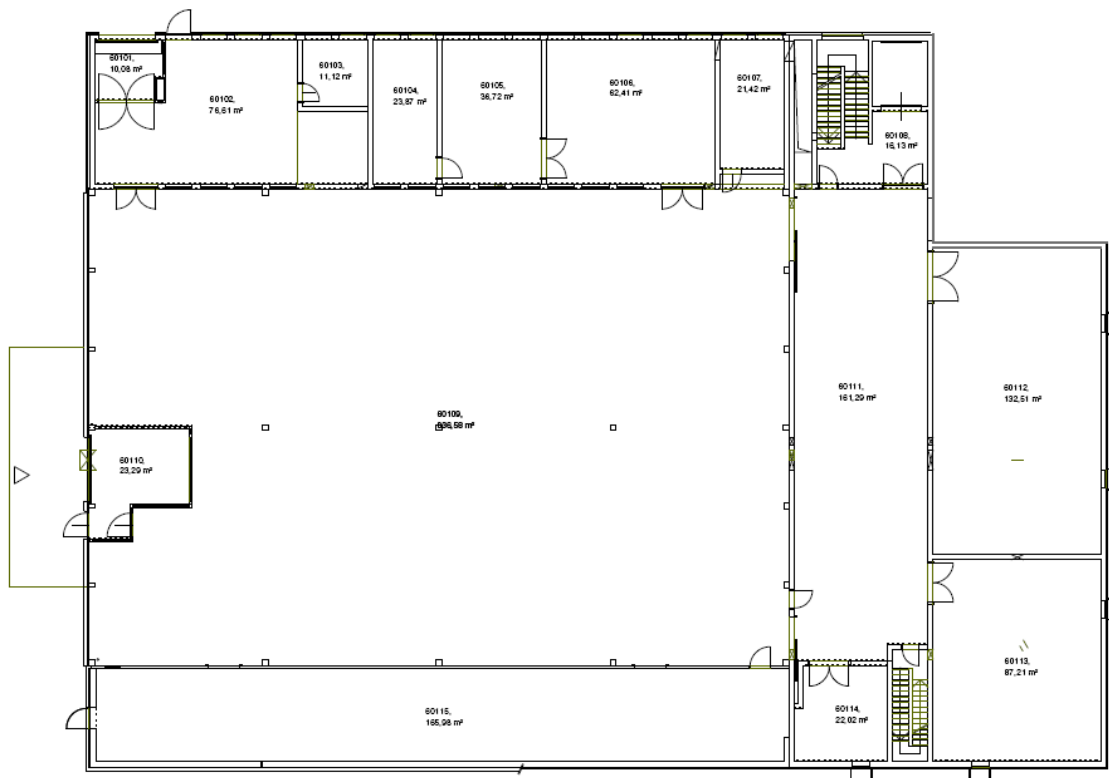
Grundriss B_60 Erdgeschoß
